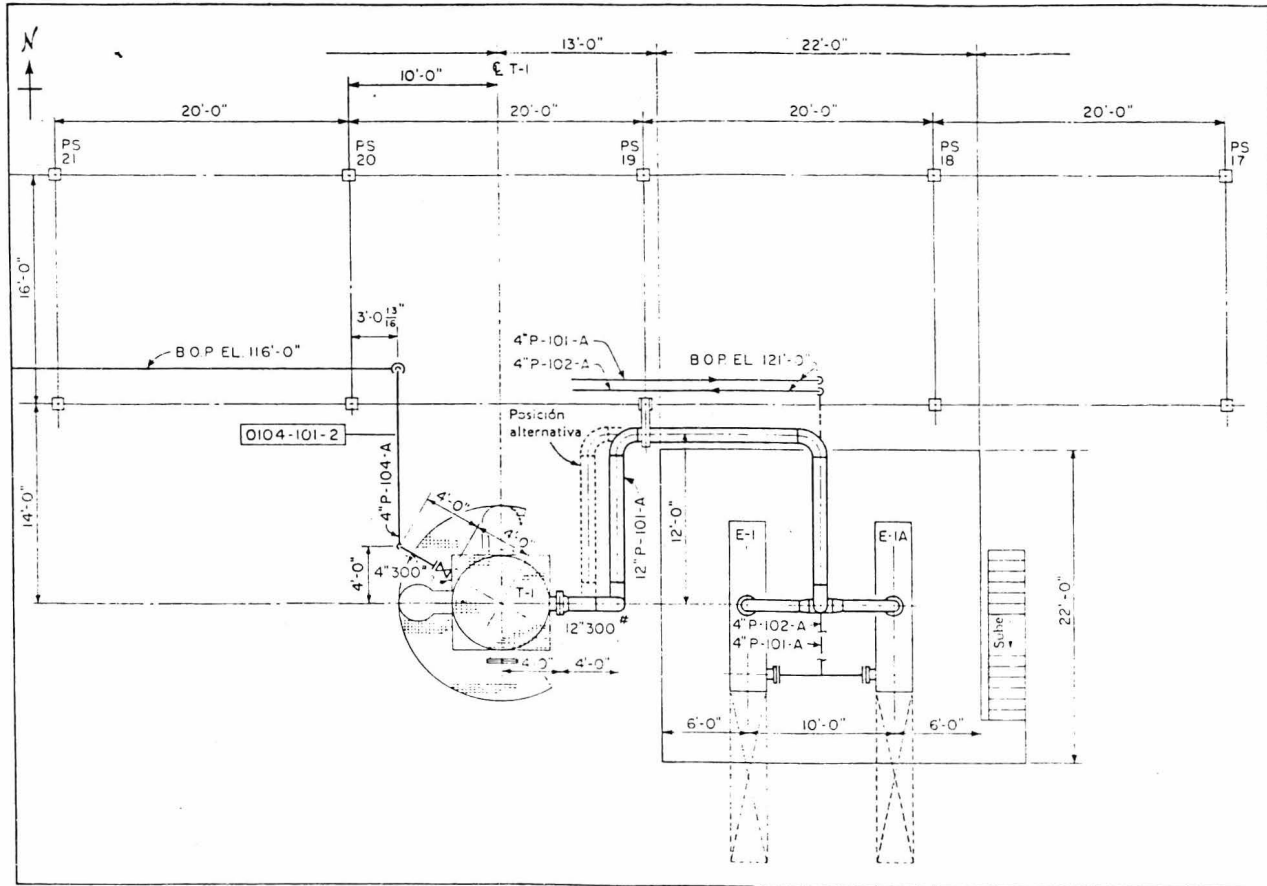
DIBUJO DE PLANTA Y SECCION DE TUBERIAS.
